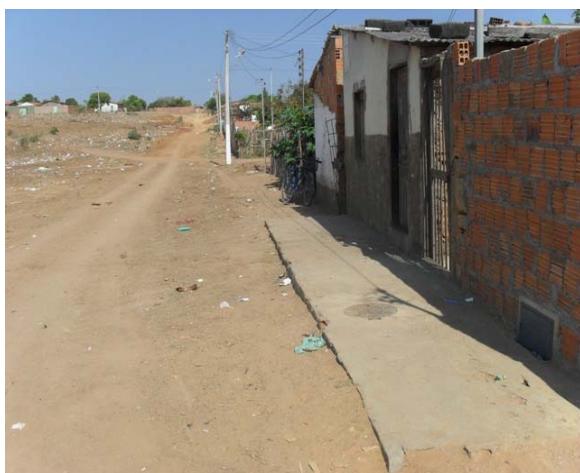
Área Crítica 2 – Loteamento Vila Maria – área de alagamento.
